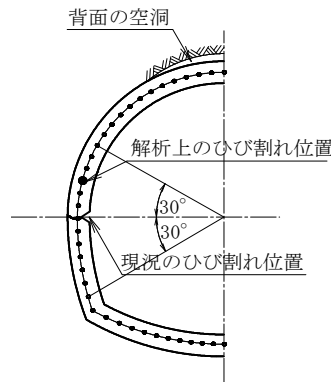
解析上のひび割れと現況のひび割れの関係
